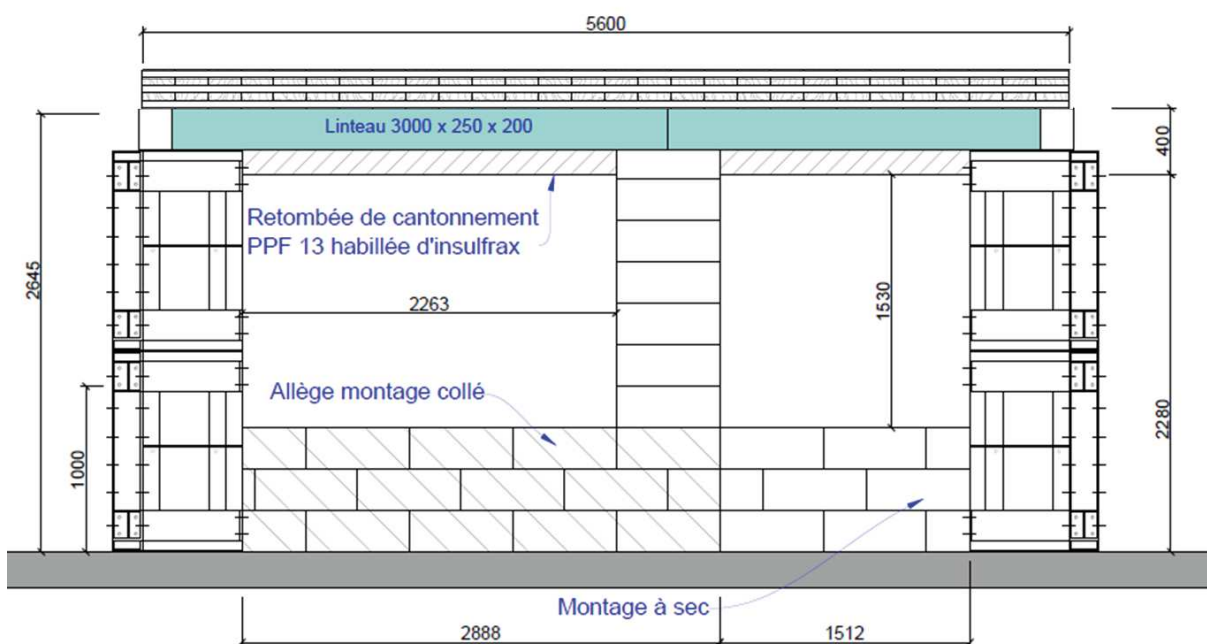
Élévation Sud de la cellule d'essai pour les essais 2 et 4 (plafond CLT)
